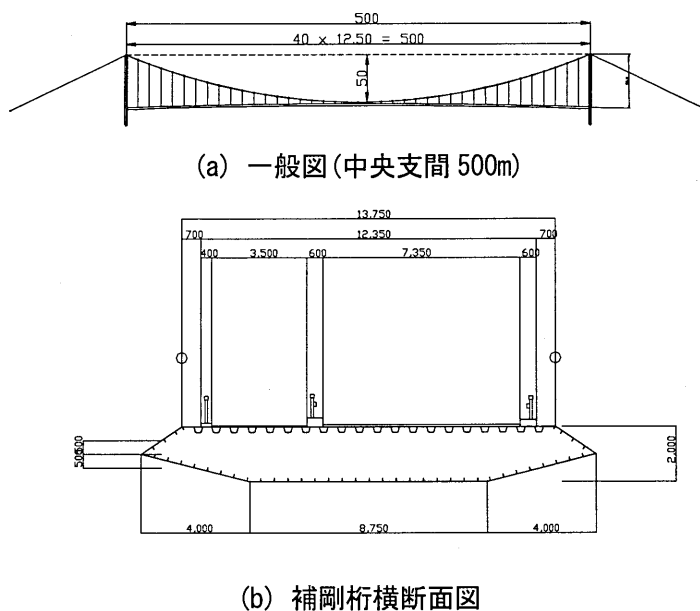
単径間吊橋モデル(寸法単位: mm)
